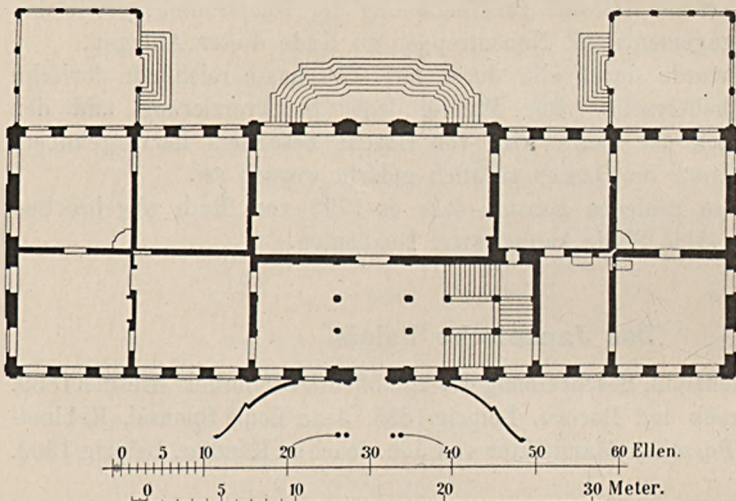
Holländisches Palais. Grundriss des Erdgeschosses.
